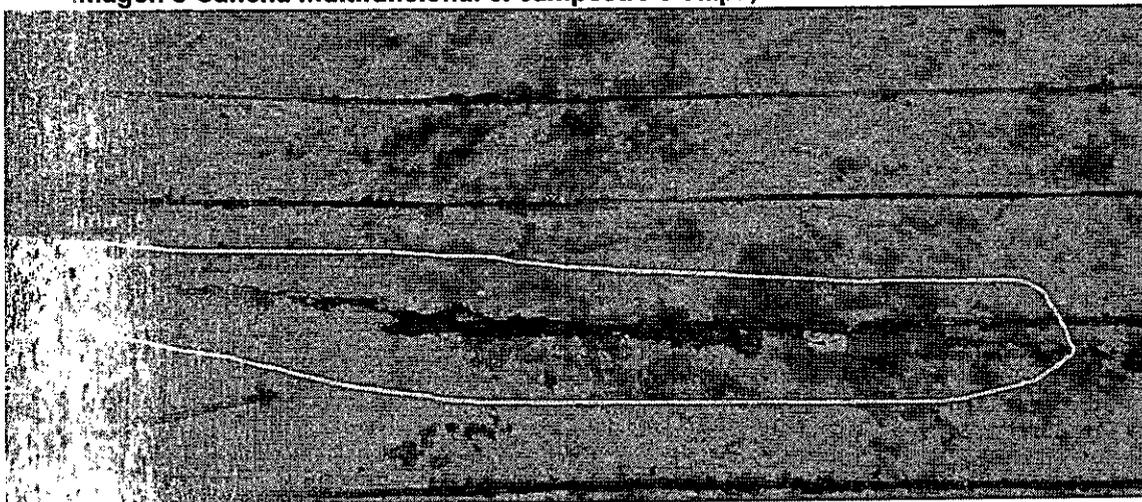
Cancha multifuncional el campestre 5 etapa, fisuras encontradas
